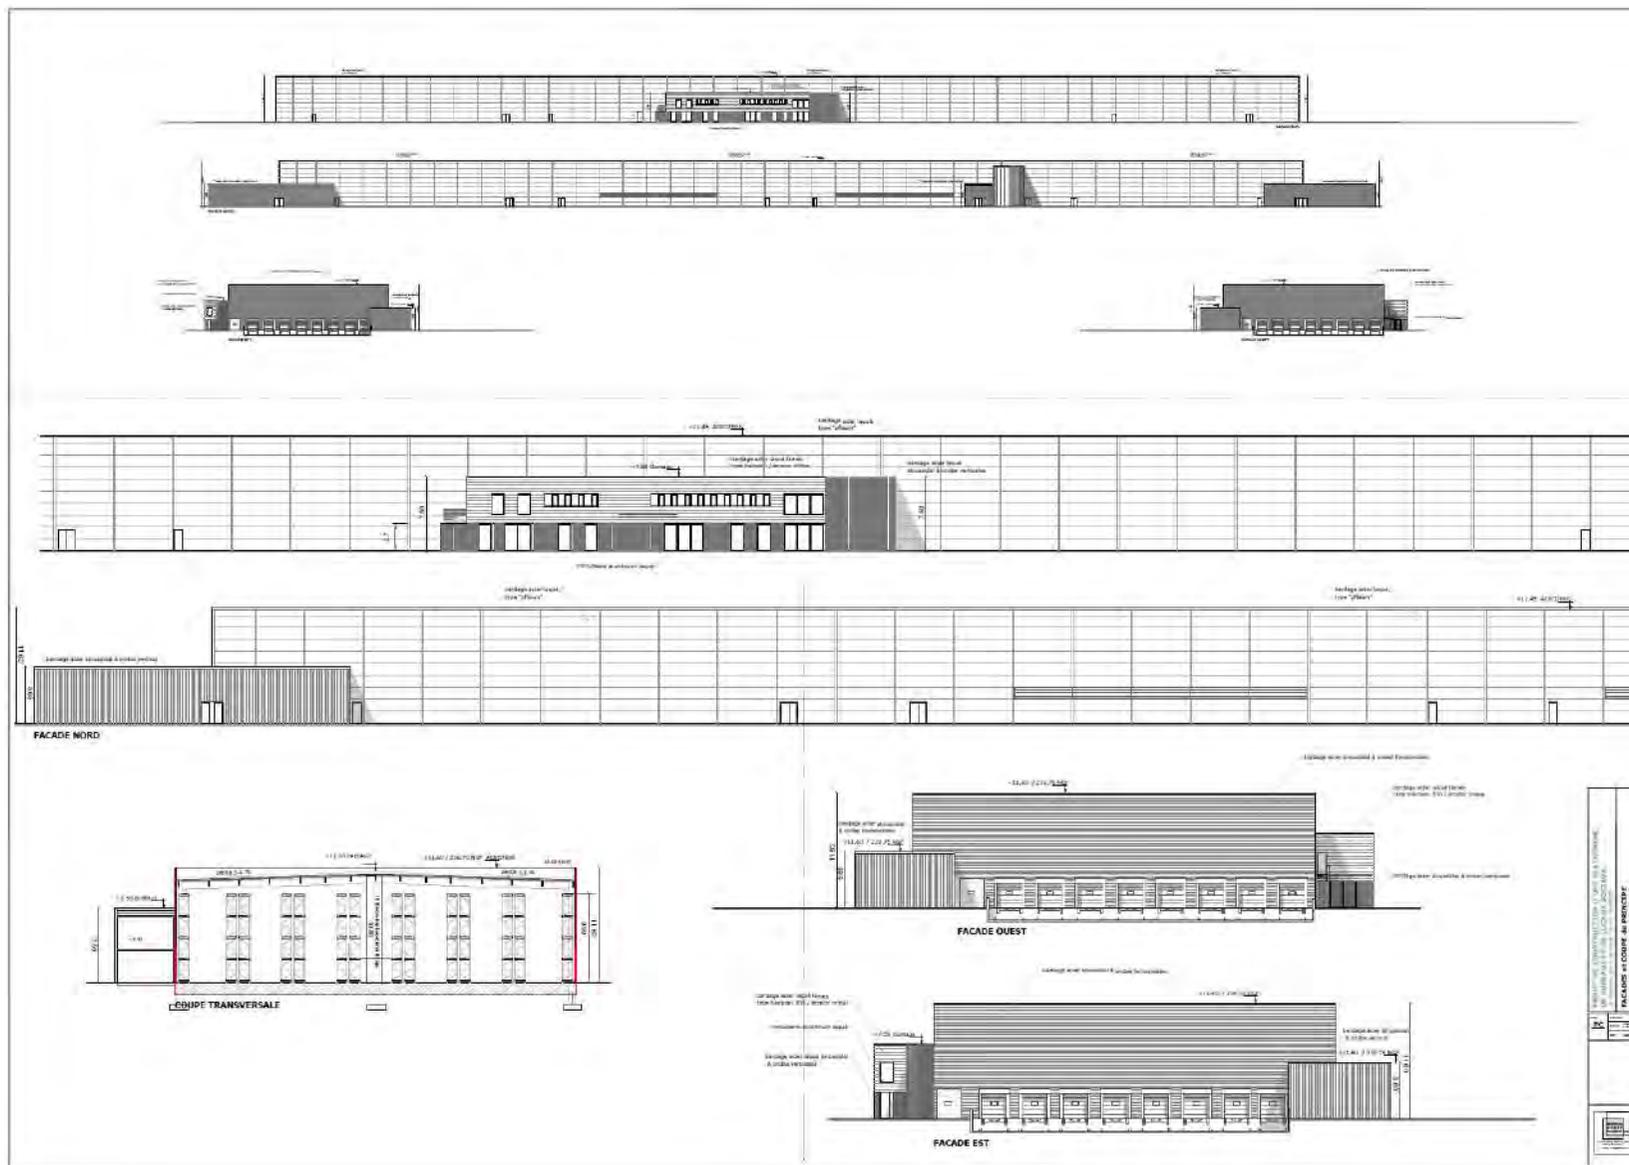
Plan en coupe et des façades (source : Architecte AUBEY Stéphane)
